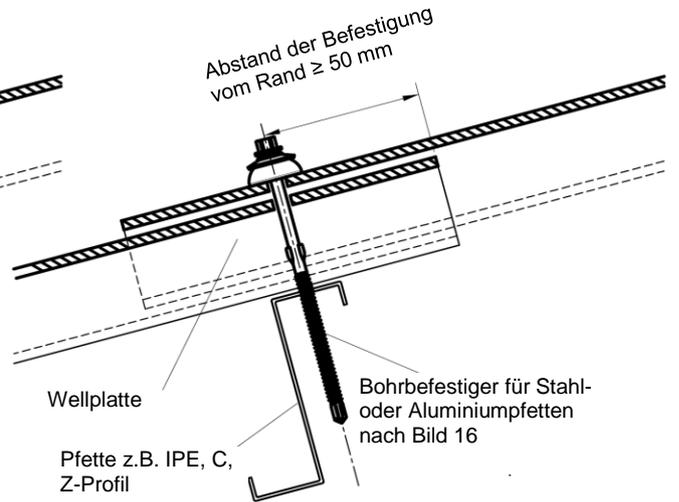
Anordnung der Befestigung auf Stahl- oder Aluminiumpfetten mit Bohrfestigern
